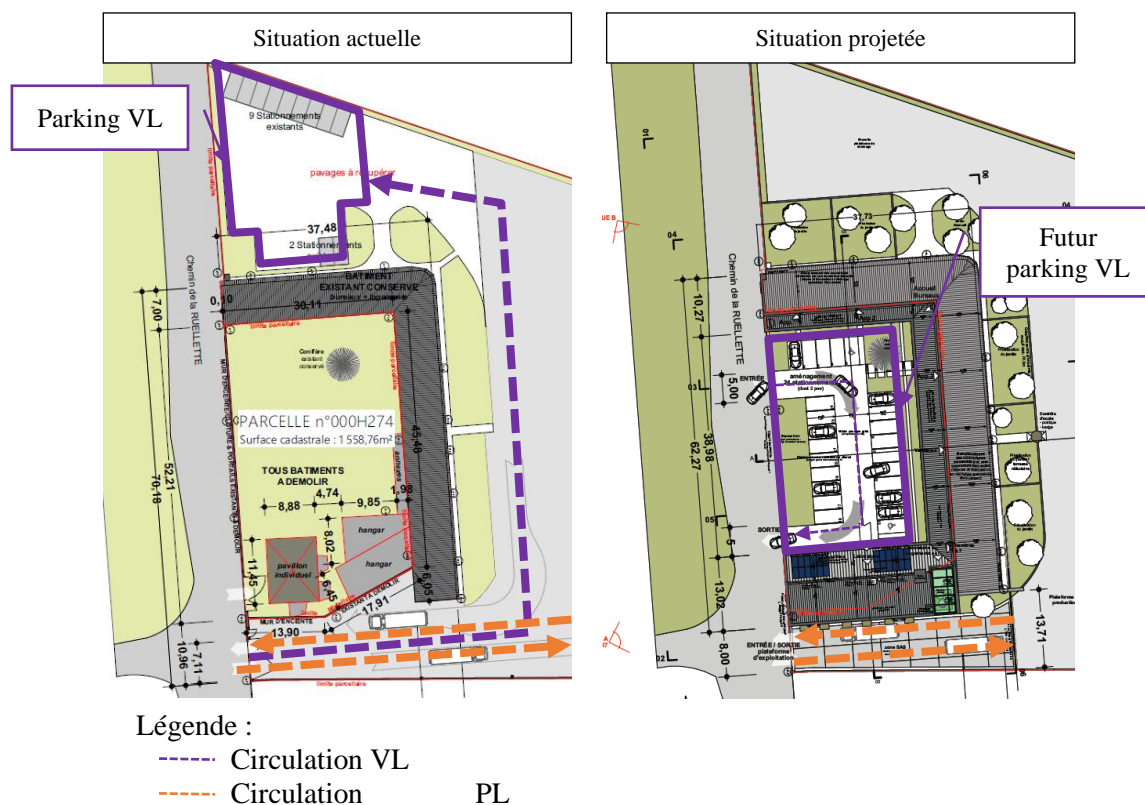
Plans de masse du Groupe Vessière à Longueil-Sainte-Marie – Situation existante et situation projetée
